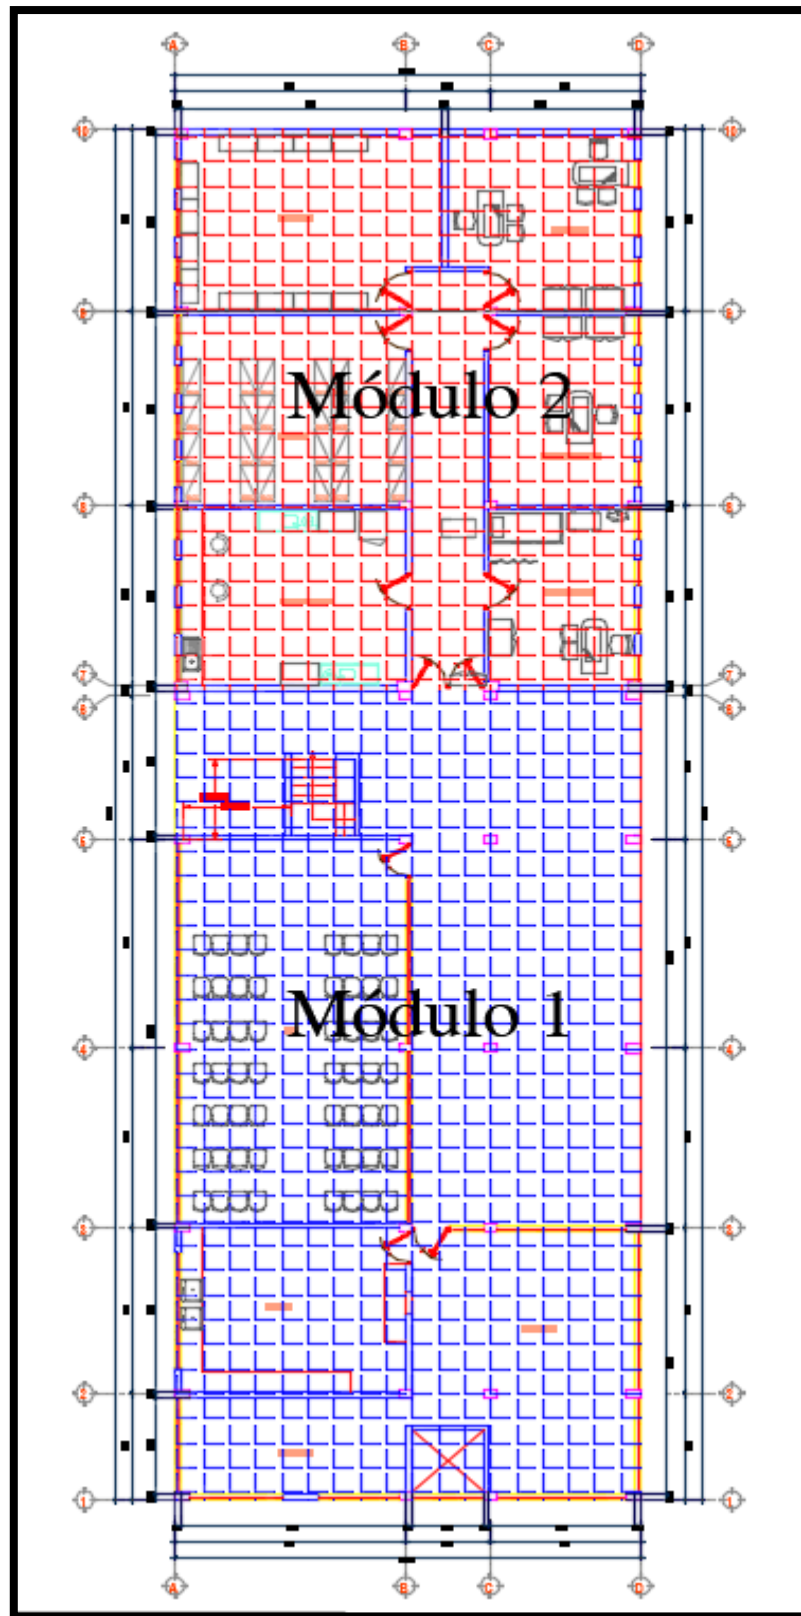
Plano arquitectónico 3er nivel del módulo 1 y 2.
